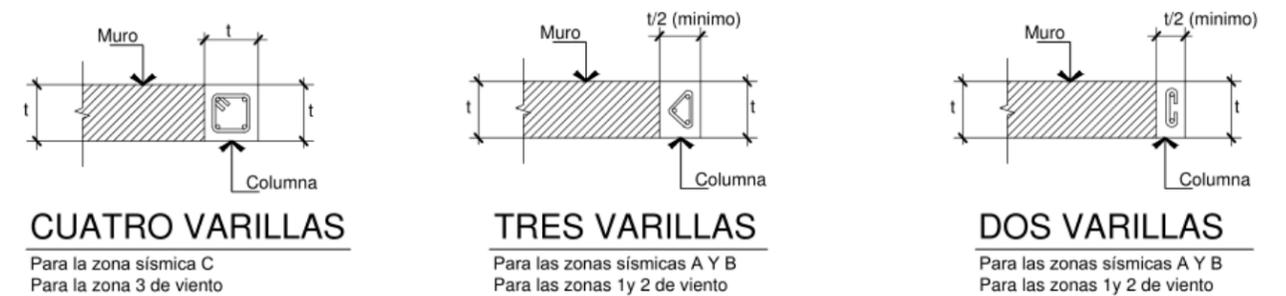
Uniones de columna-pared según zona sísmica y zona de viento. Fuente: equipo de trabajo
